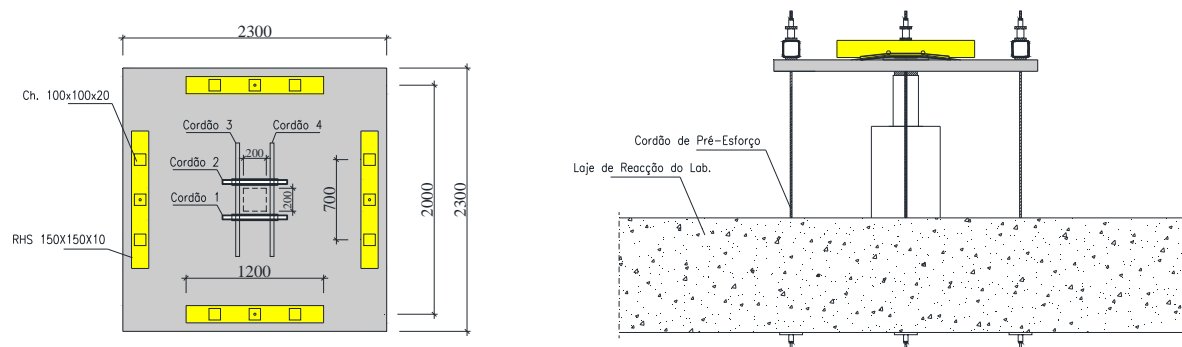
Esquema de ensaio de laje com reforço bidireccional (dimensões em mm).
